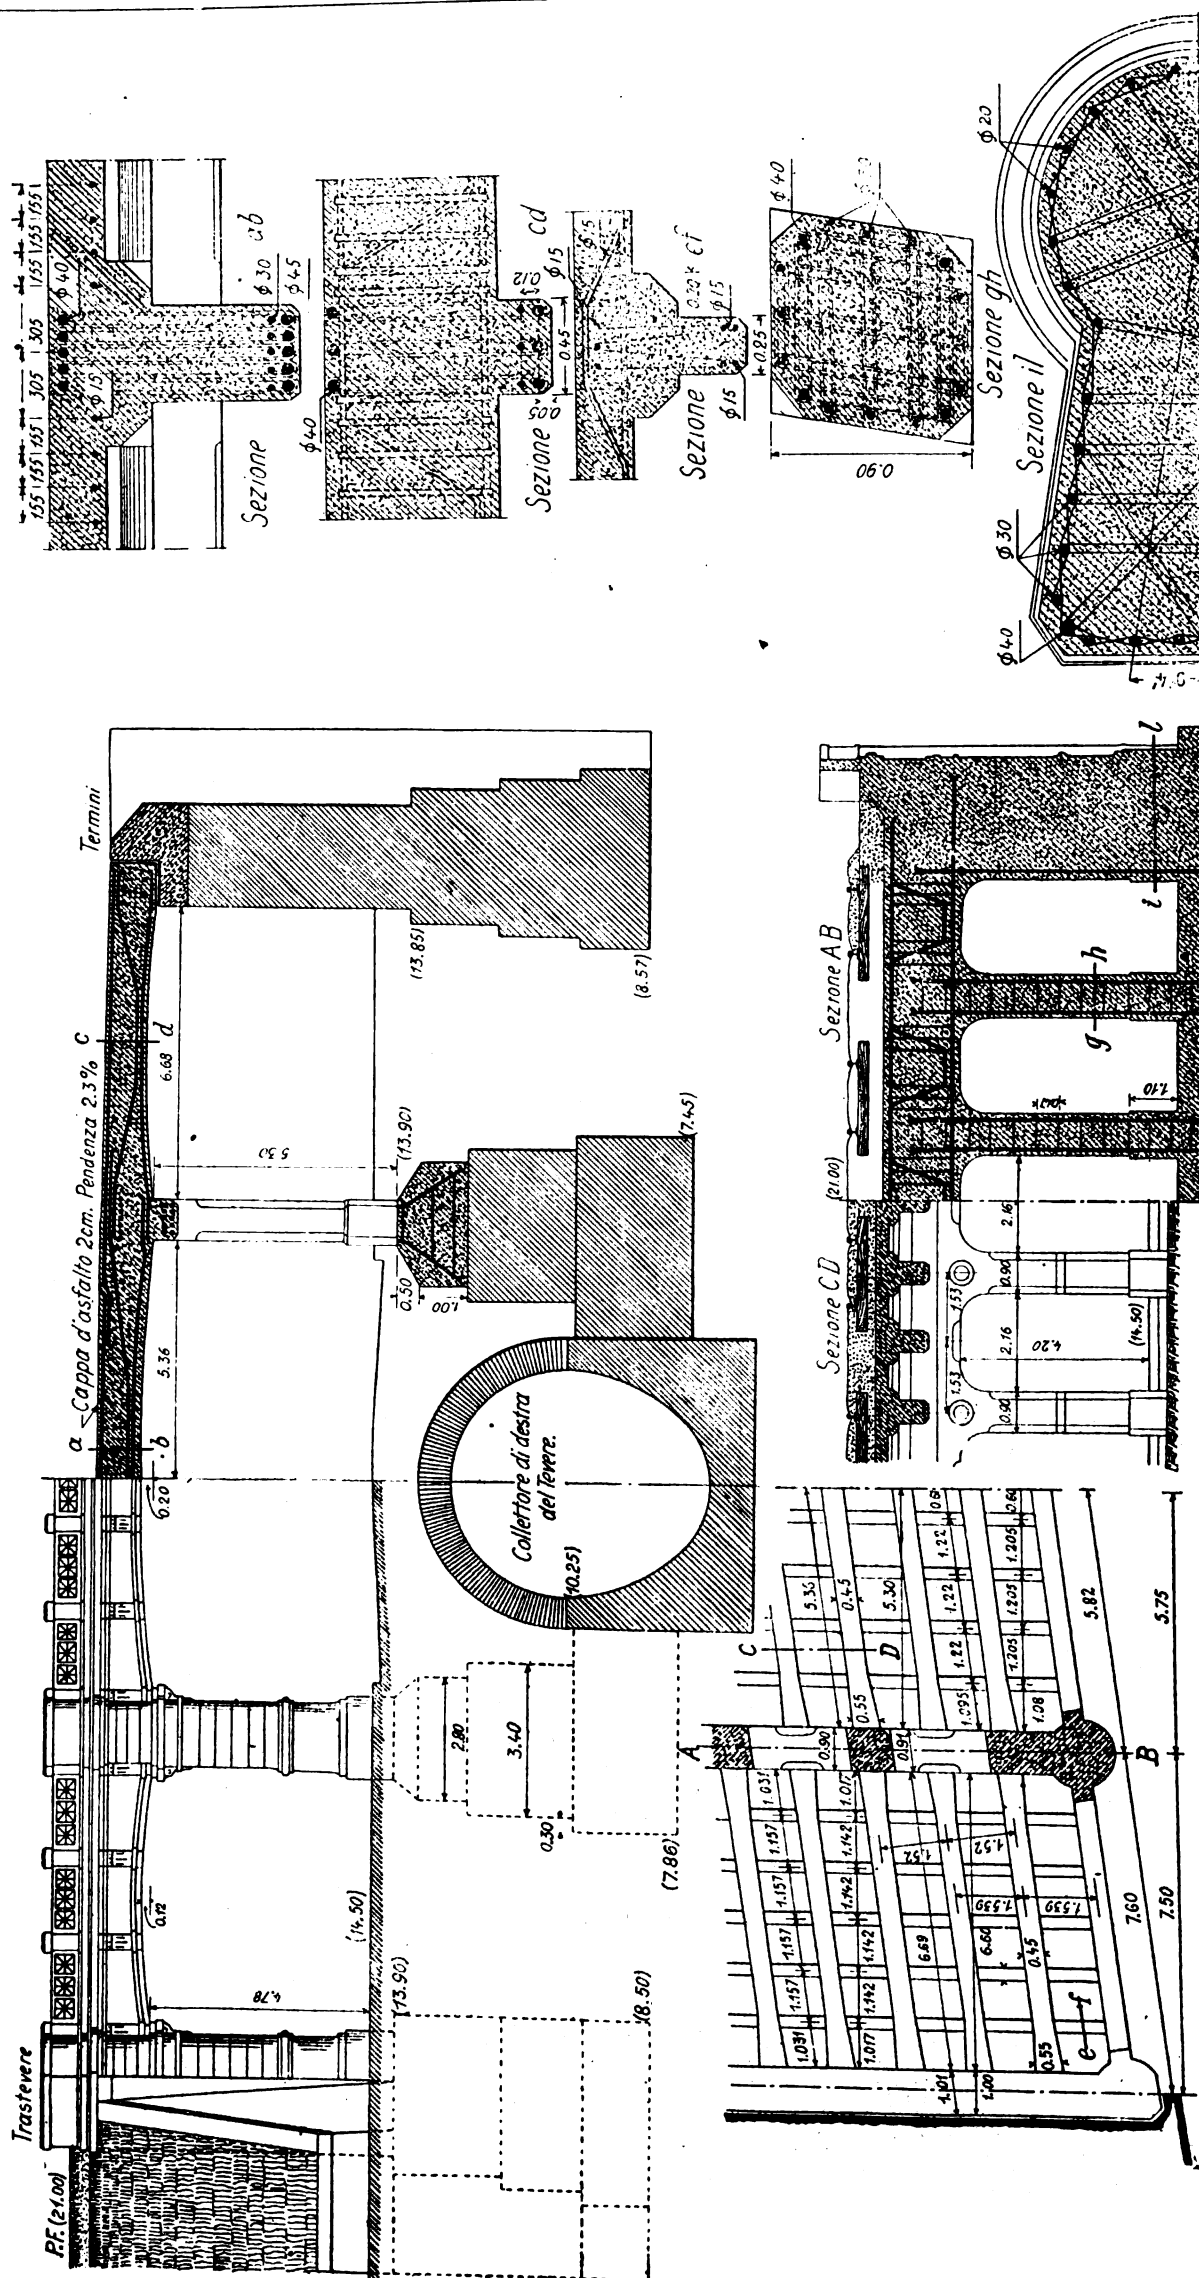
Sottovia in cemento armato sulla Via Portuense. - Elevazione, sezioni e particolari.
